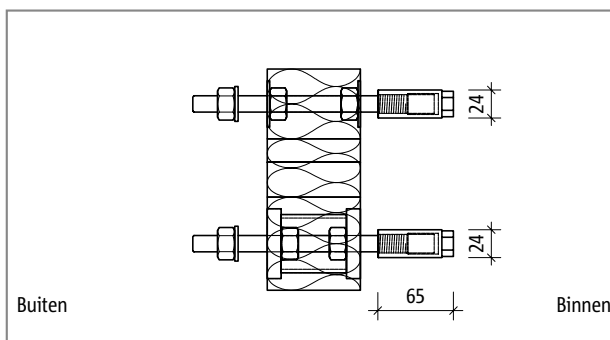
Schöck Isokorf® T type S met dopmoeren: uitkragende staalconstructie; binnen chloridehoudende atmosfeer
